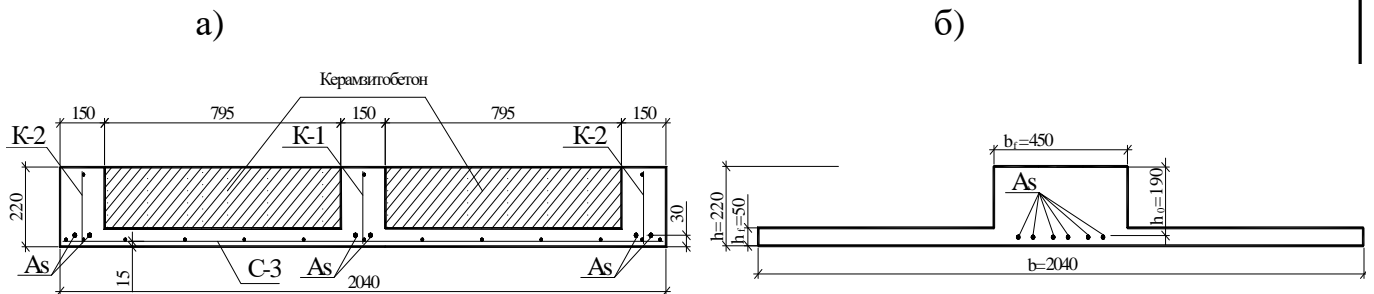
Схеми: а) поперечного перерізу плити; б) приведенного перерізу плити.
